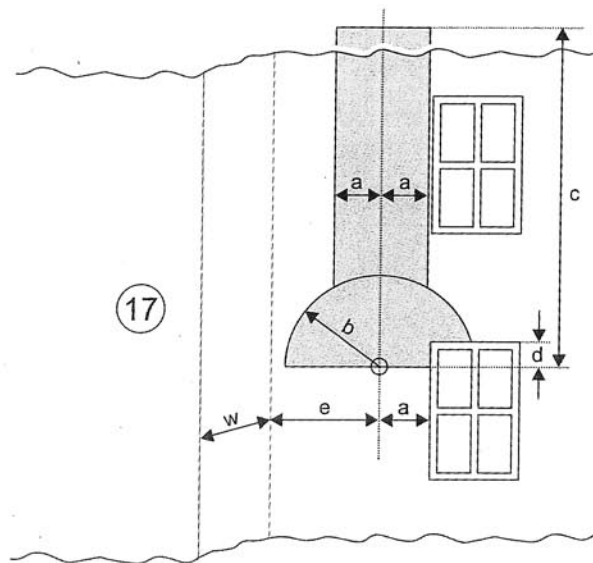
Sortie dans un façade à proximité d'un coin - sans ou verture dans la façade adjacante.
